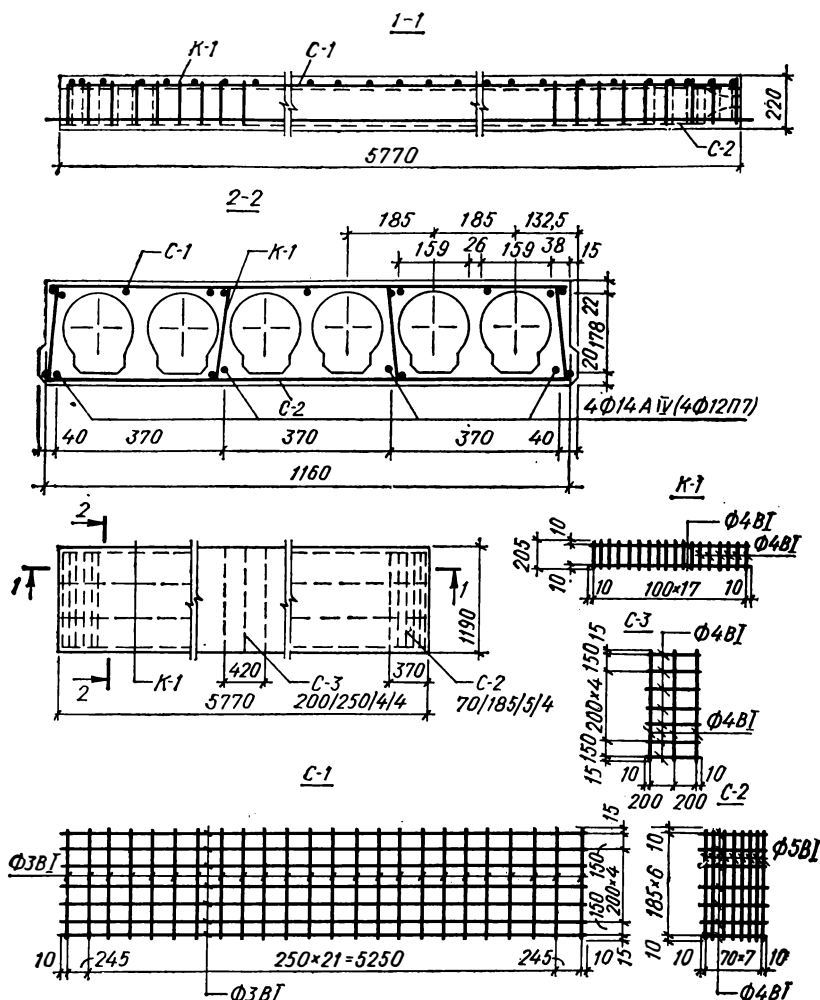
Конструкция и армирование панели перекрытия с вертикальными пустотами.
